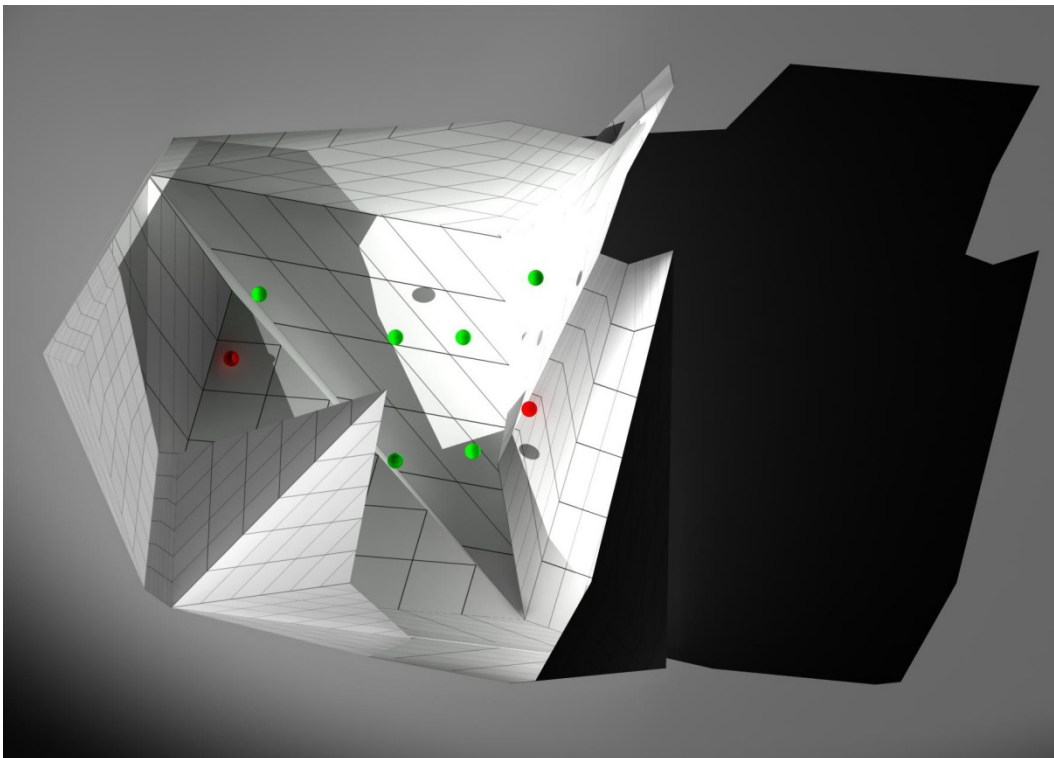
Orthogonale Grundrissprojektion des akustischen Raumes
